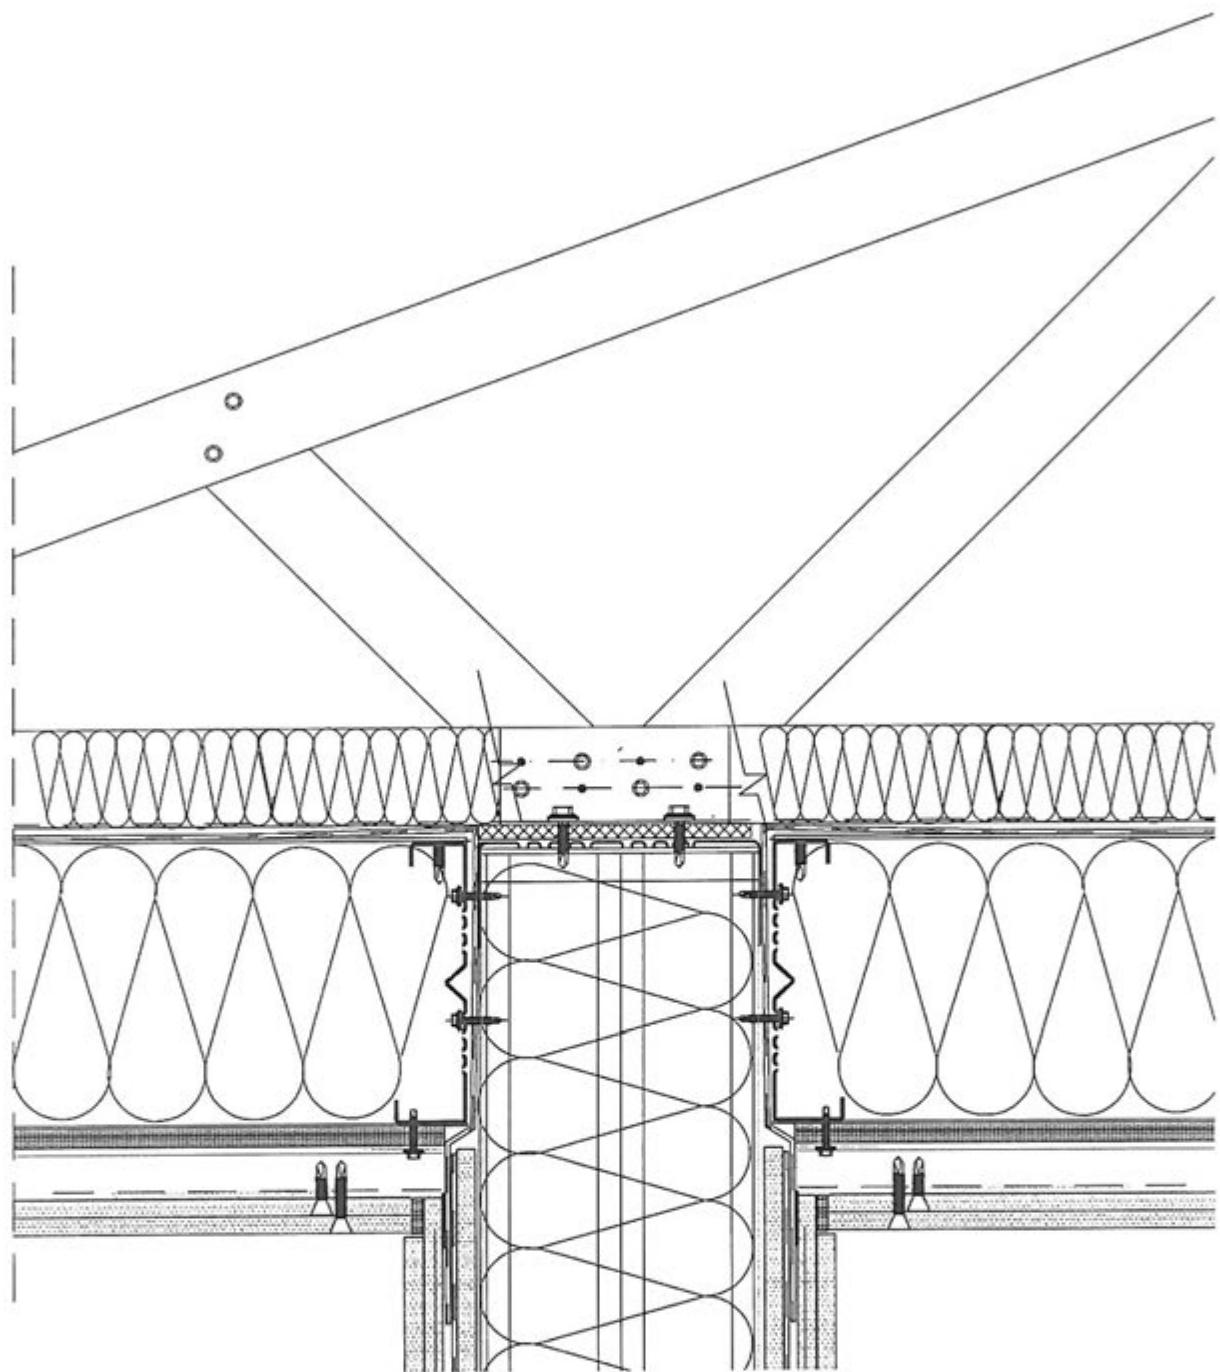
Узел крепления и примыкания конструкции чердачного перекрытия в месте опирания кровельной балки на внутреннюю несущую стеновую панель.
